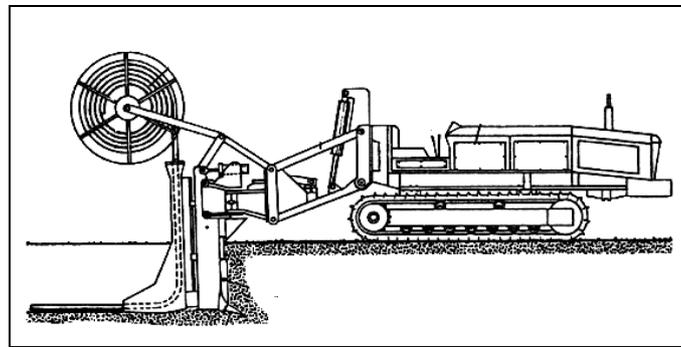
Abrezanjas para drenes de tubo de plástico.
